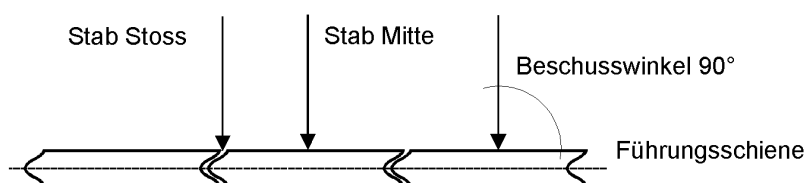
Beschussorte und Beschusswinkel beim Rollladen als Dachbauteil im Seitenriss
